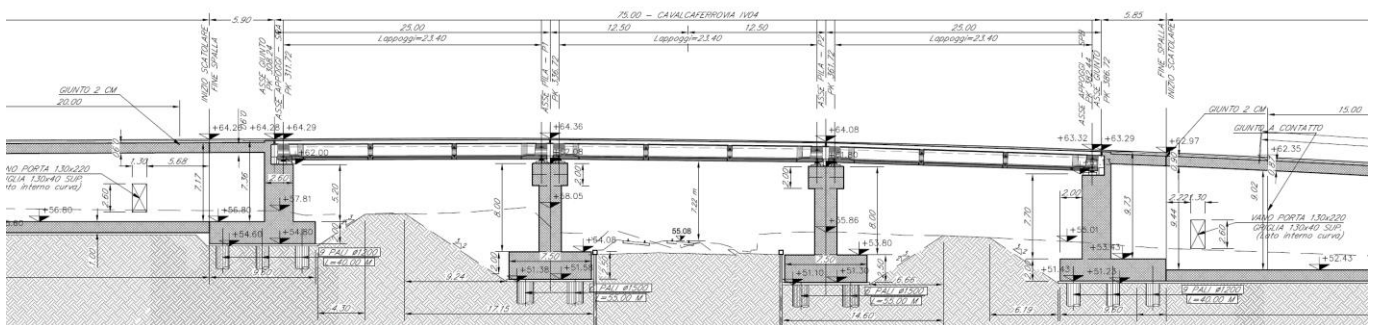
Sezione longitudinale del Cavalcaferrovia
